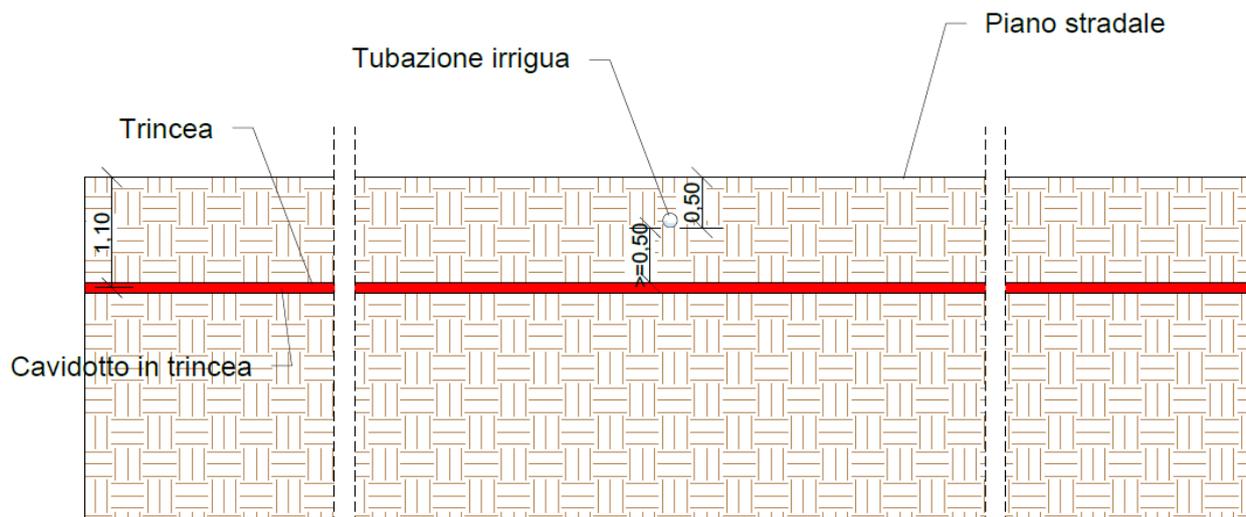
Attraversamento tubazione irrigua n. 31 - Sezione tipologica attraversamento in trincea
